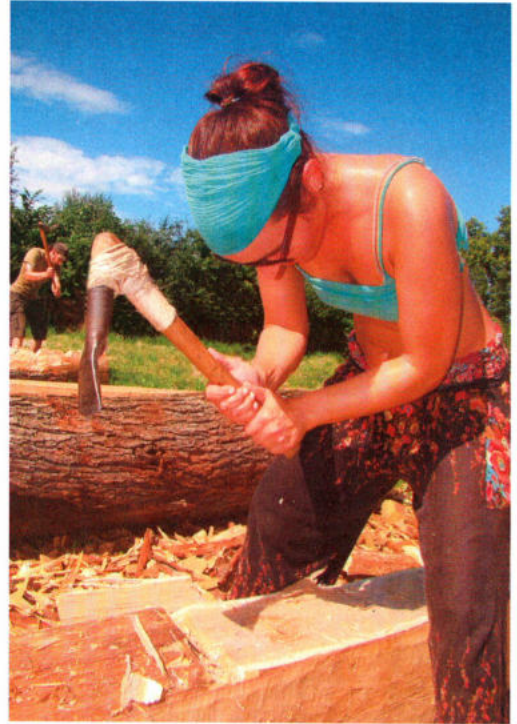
Um die Oberflächen der rechteckigen Bauhölzer zu glätten, wurden bei der finalen Feinarbeit Lappendeckeln auf Knieholzschäftungen eingesetzt. – To give the rectangular building woods a smooth finish we used adzes on kneehaftings.
